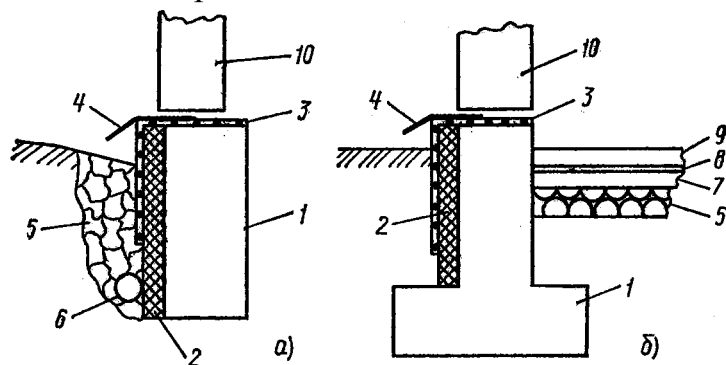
Фундамент гелиотеплицы с теплоизоляцией (а) и влагозащитой (б)
